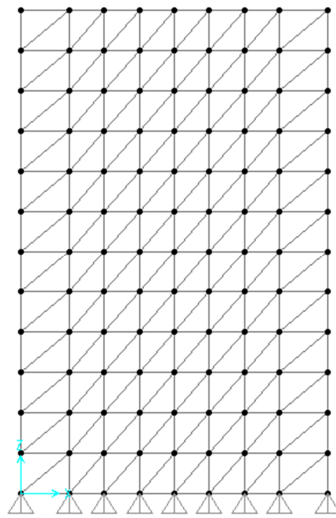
Configuração dos Planos de Contraventamento Vertical Com Elementos de Contraventamento Pequenos
